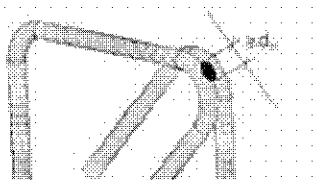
Конструкция нахлесточного соединения для замкнутых арматурных элементов.
